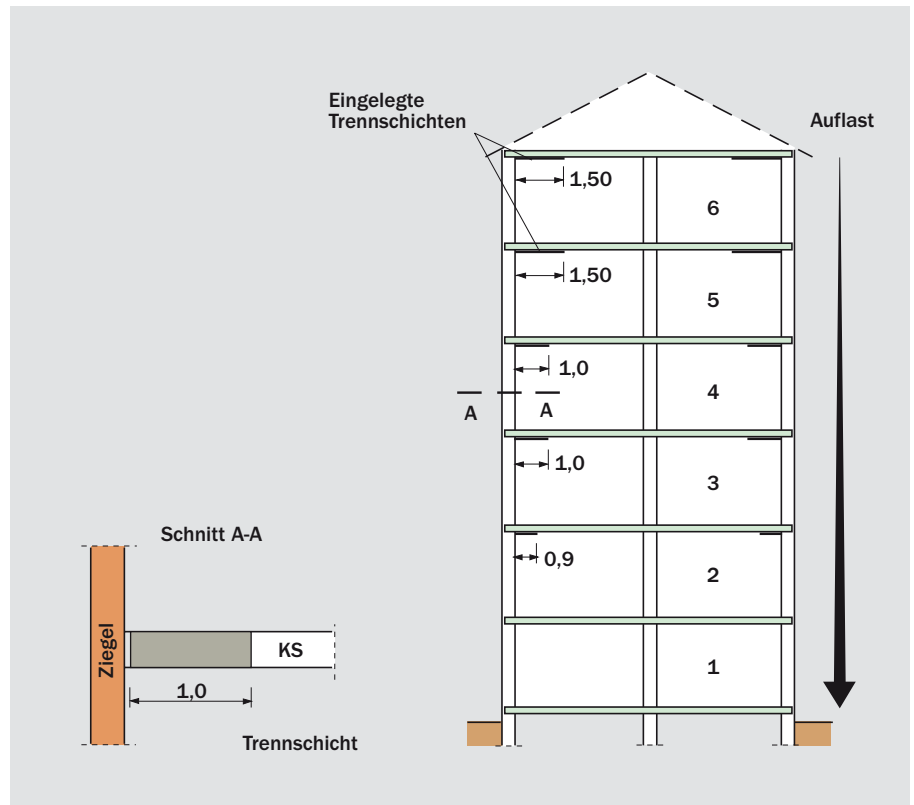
Stumpfstoßtechnik; eingelegte Trennschichten in der Innenwand
